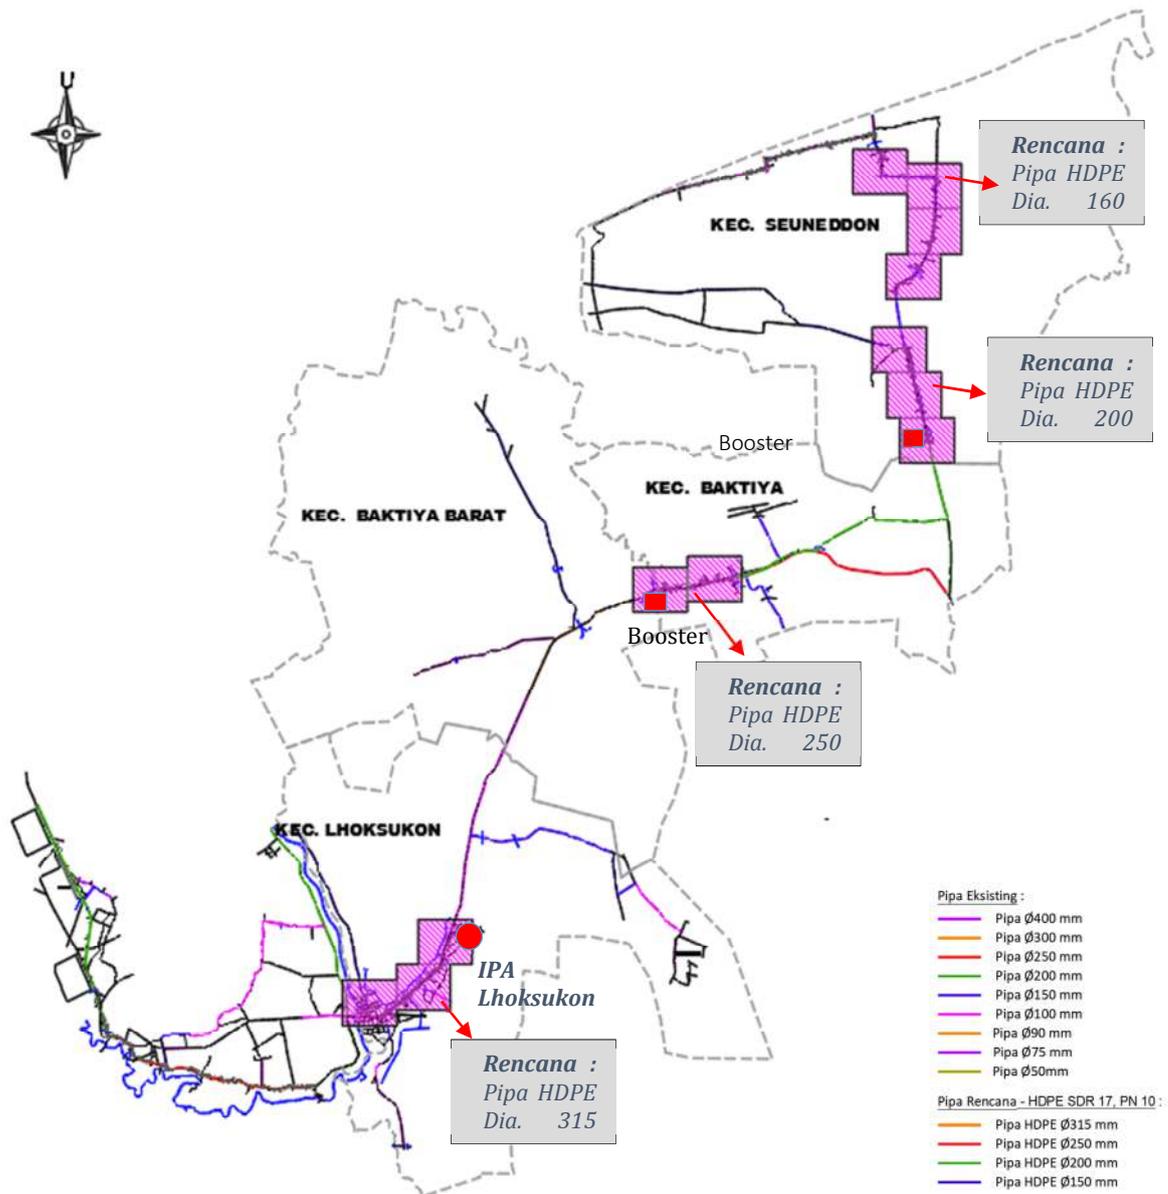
Lay Out Jaringan Pipa Eksisting
